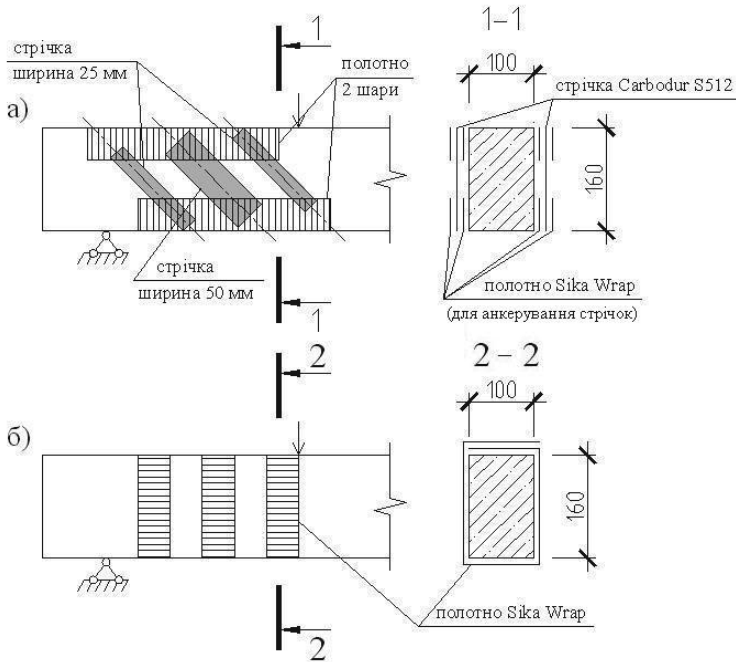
Схеми підсилення похилих перерізів балок шляхом наклеювання на поверхню бетону:
